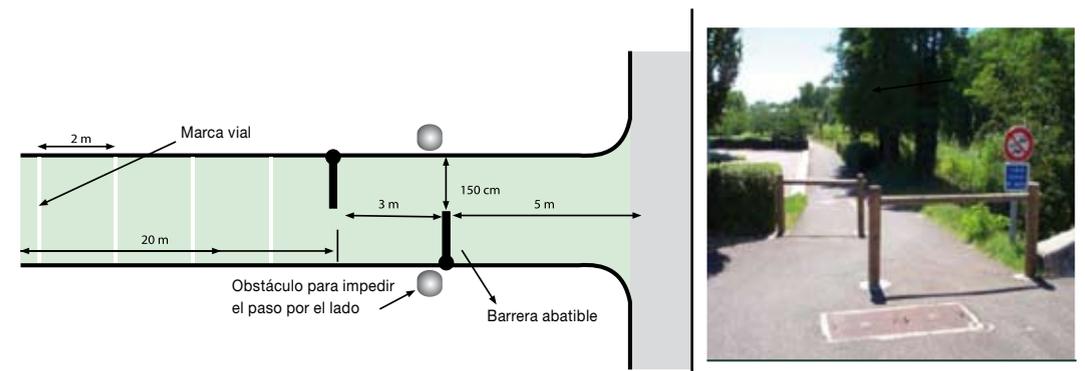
Chicana para restricción de acceso a la vía ciclista
